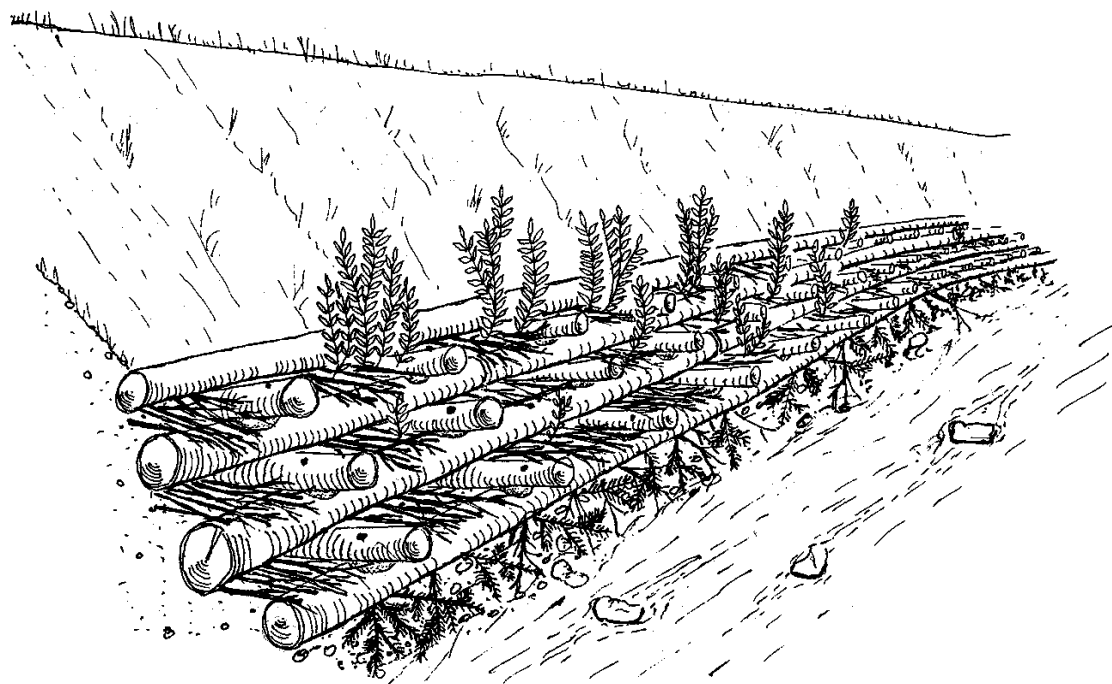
Palificata viva spondale a una parete - vista prospettica.
